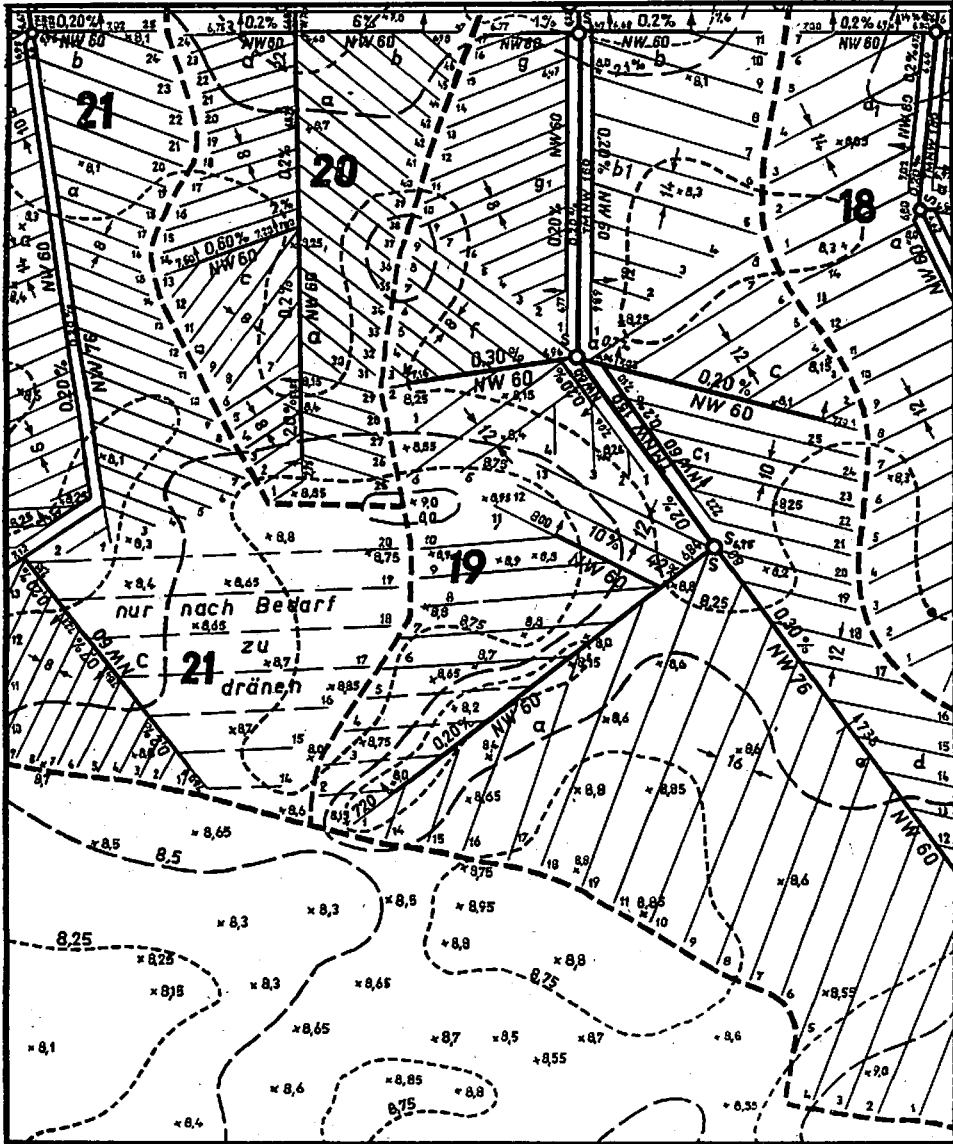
Lageplan — Ausschnitt eines Dränprojektes (Tonrohrdränung mit Plastrohrsammlern)
